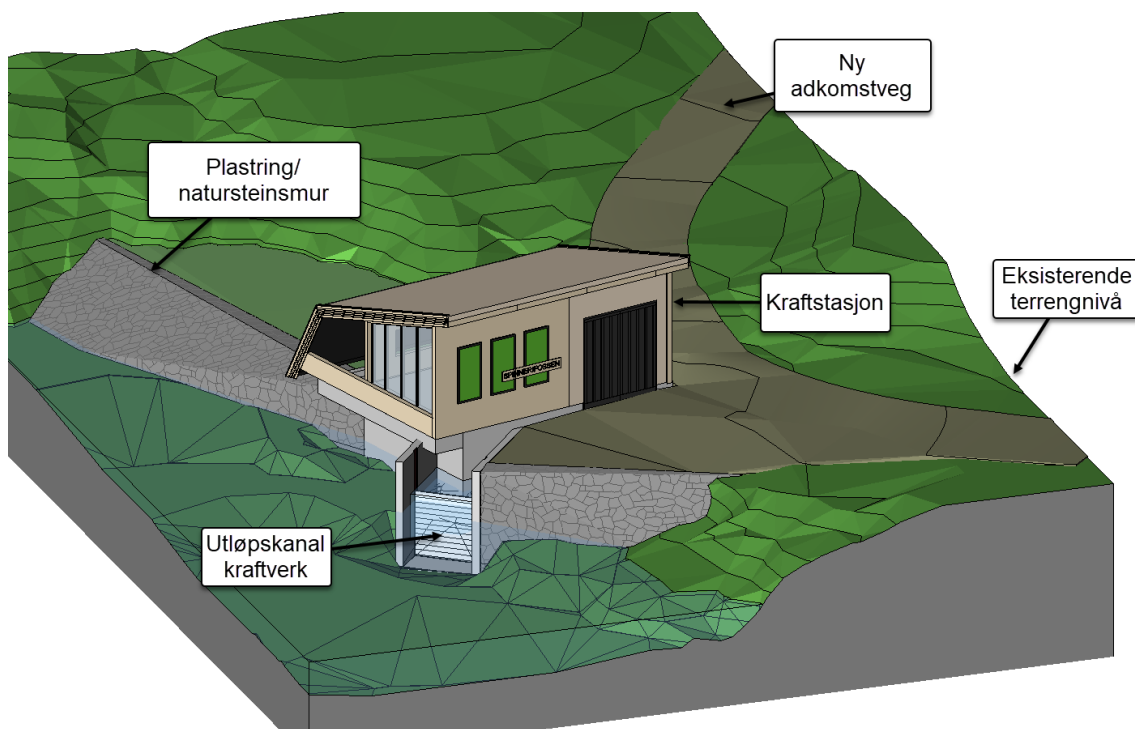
Plansnitt - prinsipp kraftstasjon
